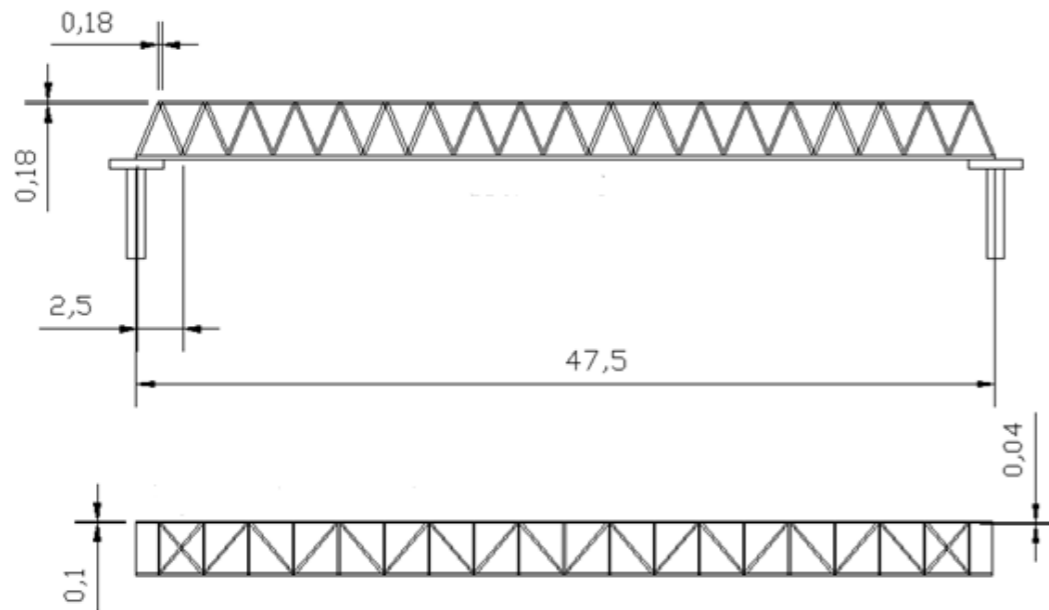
Alzado y planta pasarela peatonal tipo Warren.
